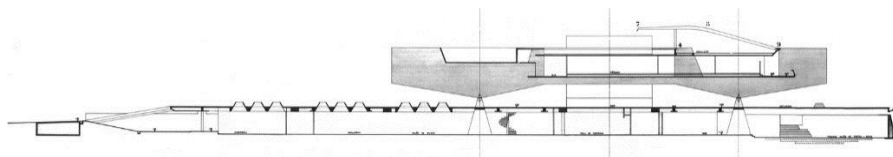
Corte longitudinal do Clube XV (Fonte: ESPALLARGAS, 2016)
